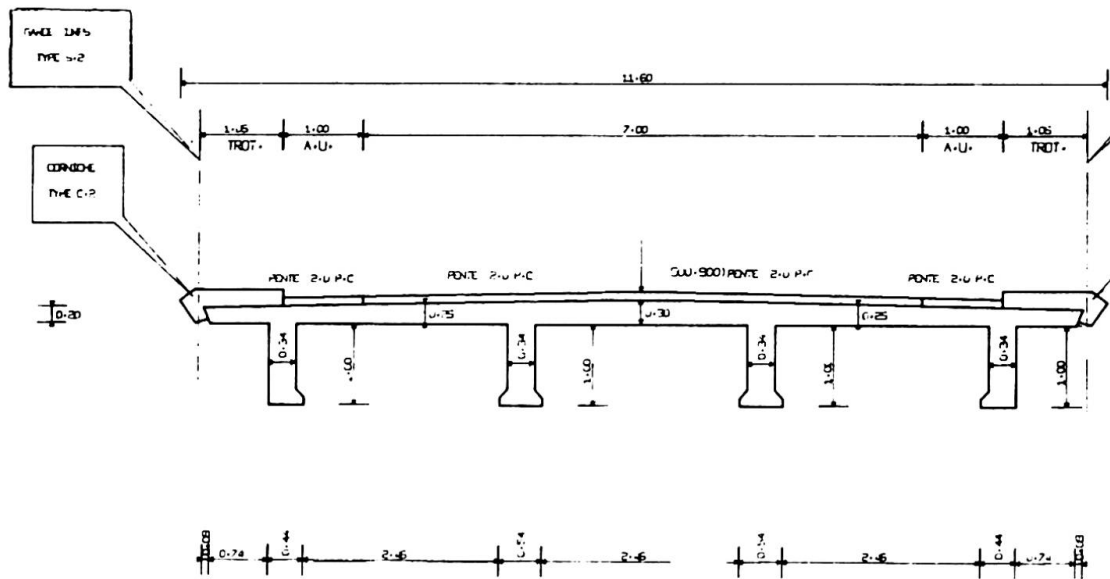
Coupe transversale de tablier à poutres sous chaussée automatiquement dessinée par traceur de courbes.
